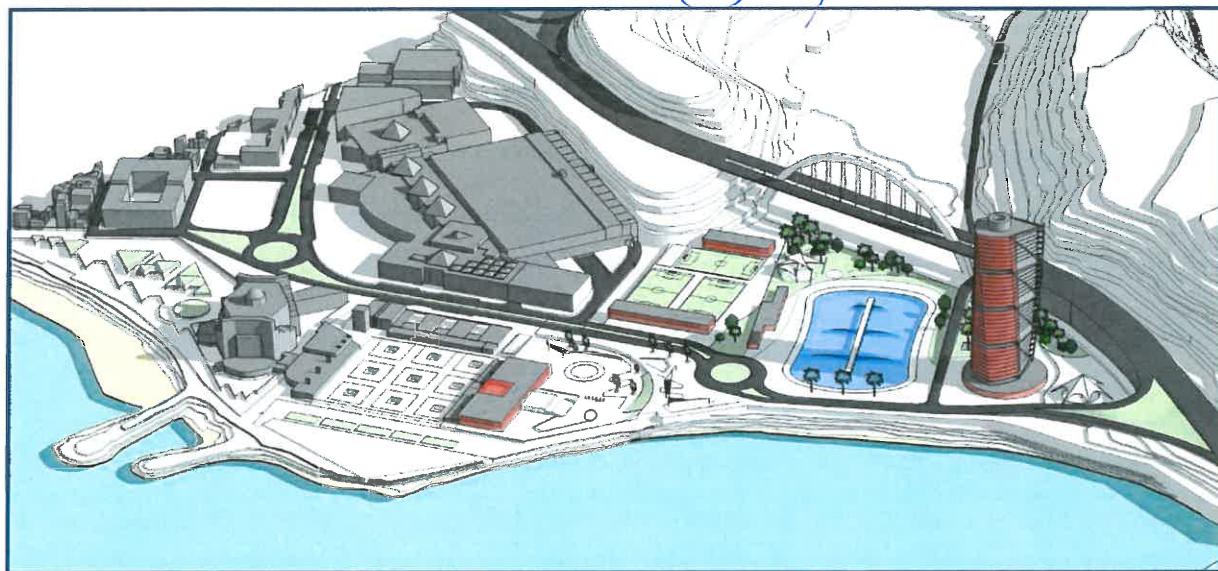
Alternativa 2. Imagen de la volumetría 1. Fuente: elaboración propia
